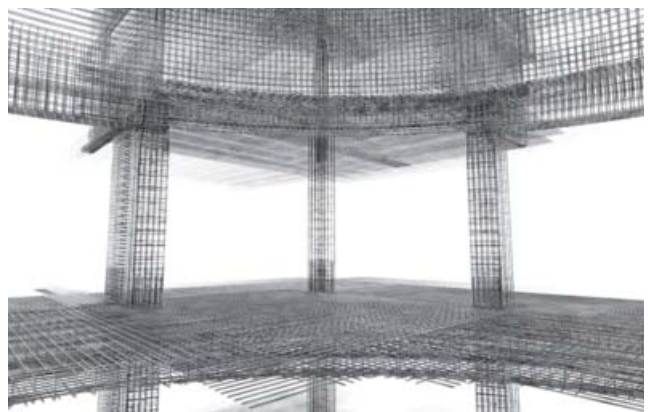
3D-Bewehrungsdarstellung Übersicht Deckenausschnitt
